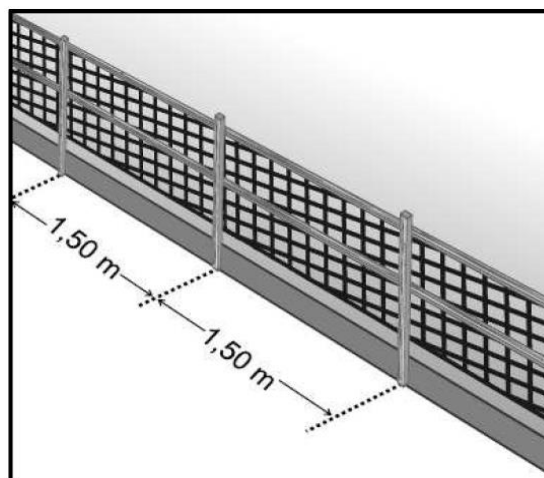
Espaçamento horizontal do guarda corpo – rodapé
